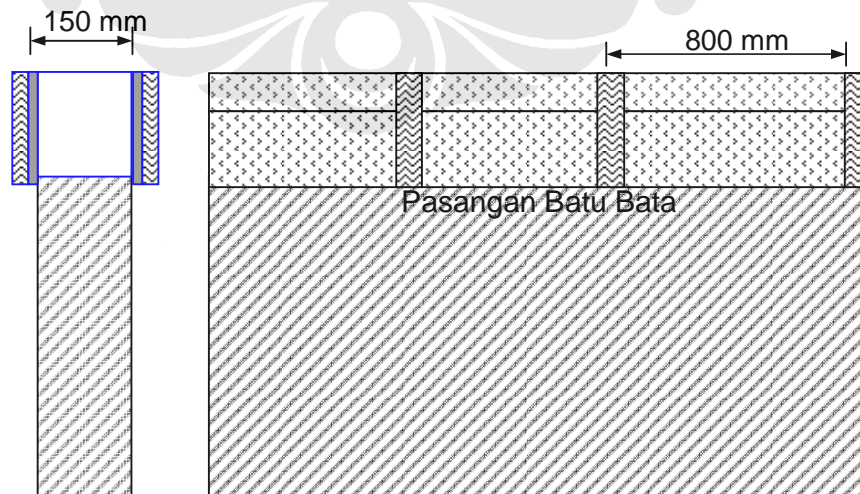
Bekisting cara tradisional elemen pedestal pondasi
